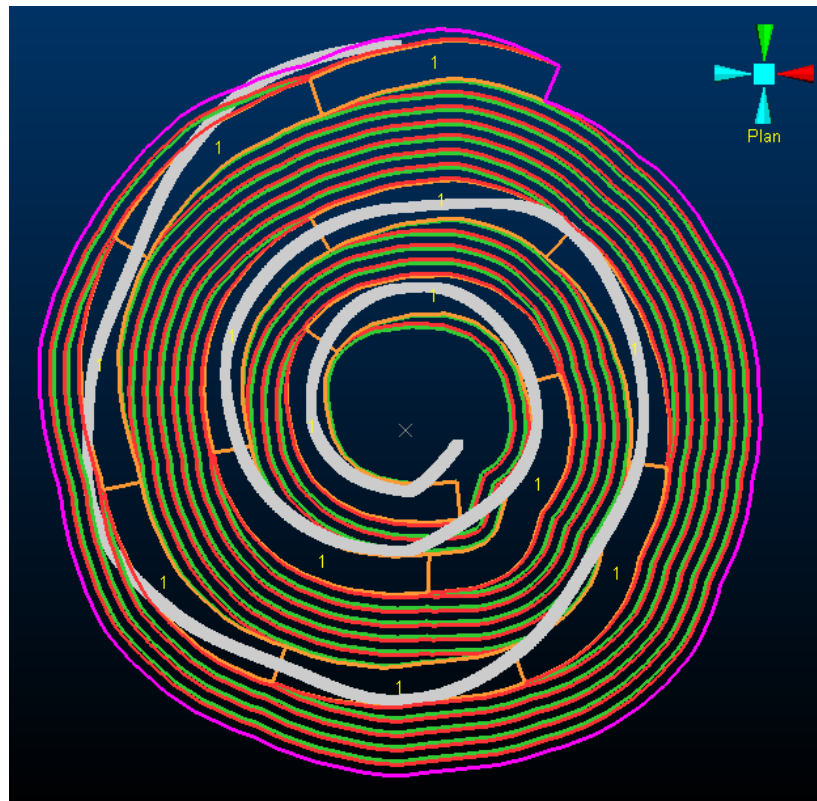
Vista planta ajuste pit suavizado y línea de puntos
